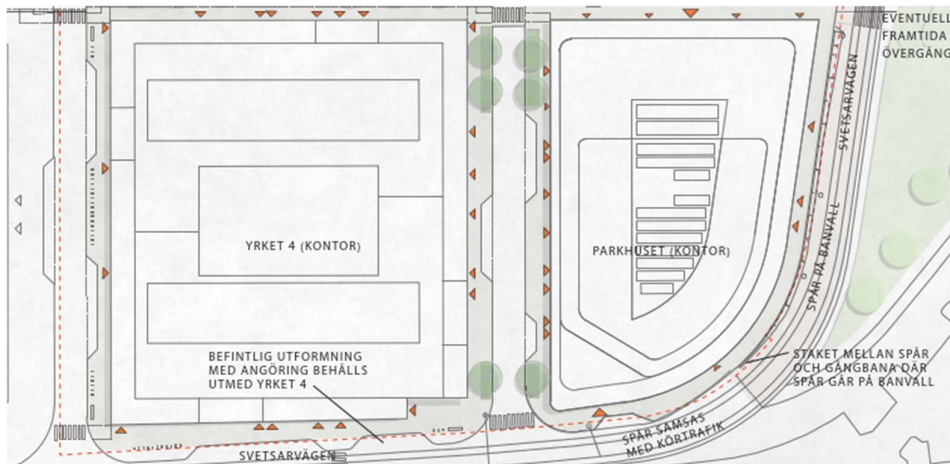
Illustrationsplan för planområdet kvarteret Yrket m.fl.
